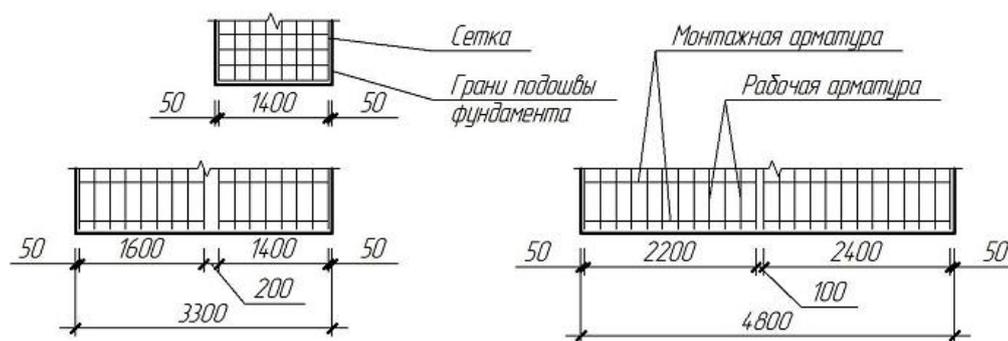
Пример схем раскладки сварных унифицированных сеток одного слоя по подошвам отдельных фундаментов
